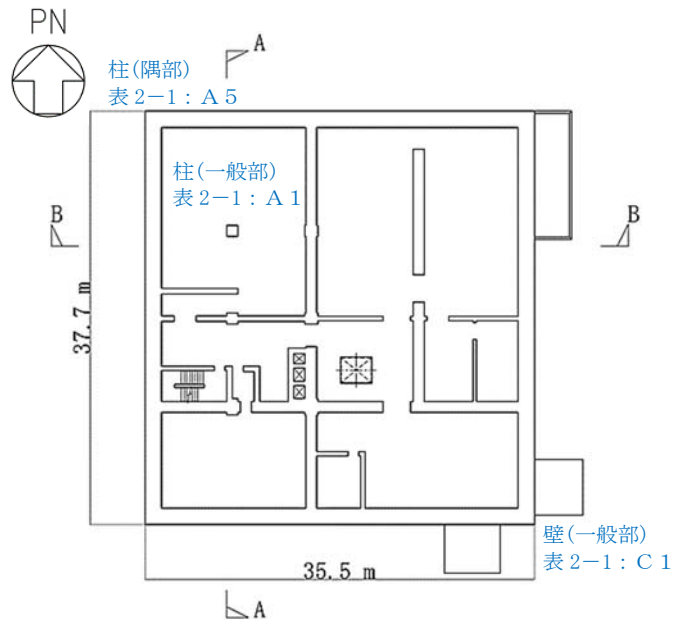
緊急時対策所建屋の概略平面図 (EL. 37.0 m)
